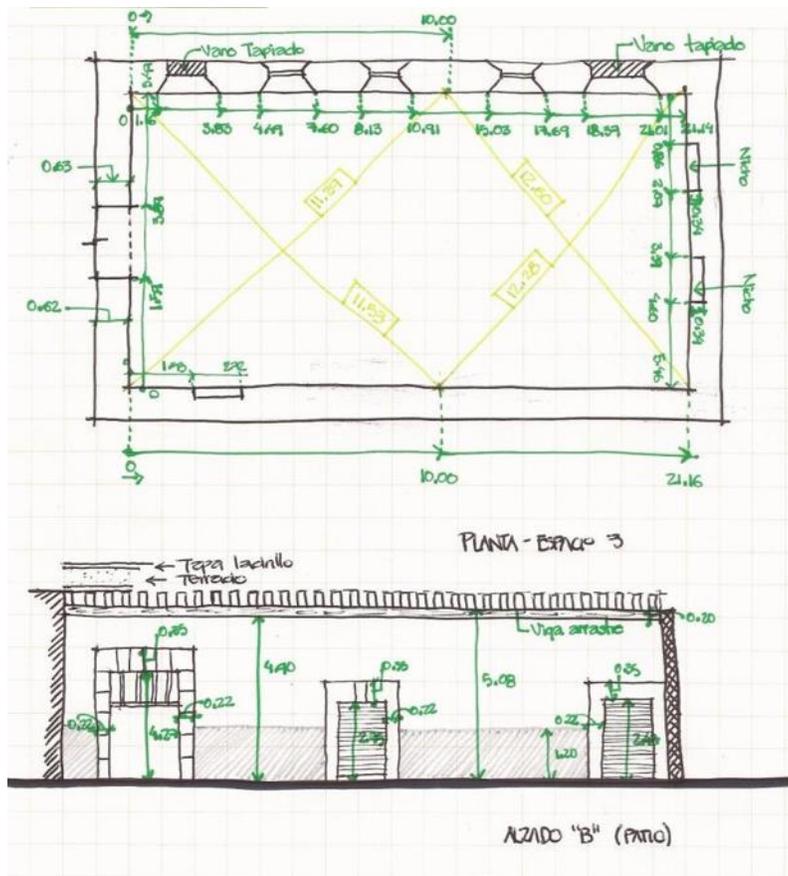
Croquis que se realizaron en la etapa de levantamiento.
